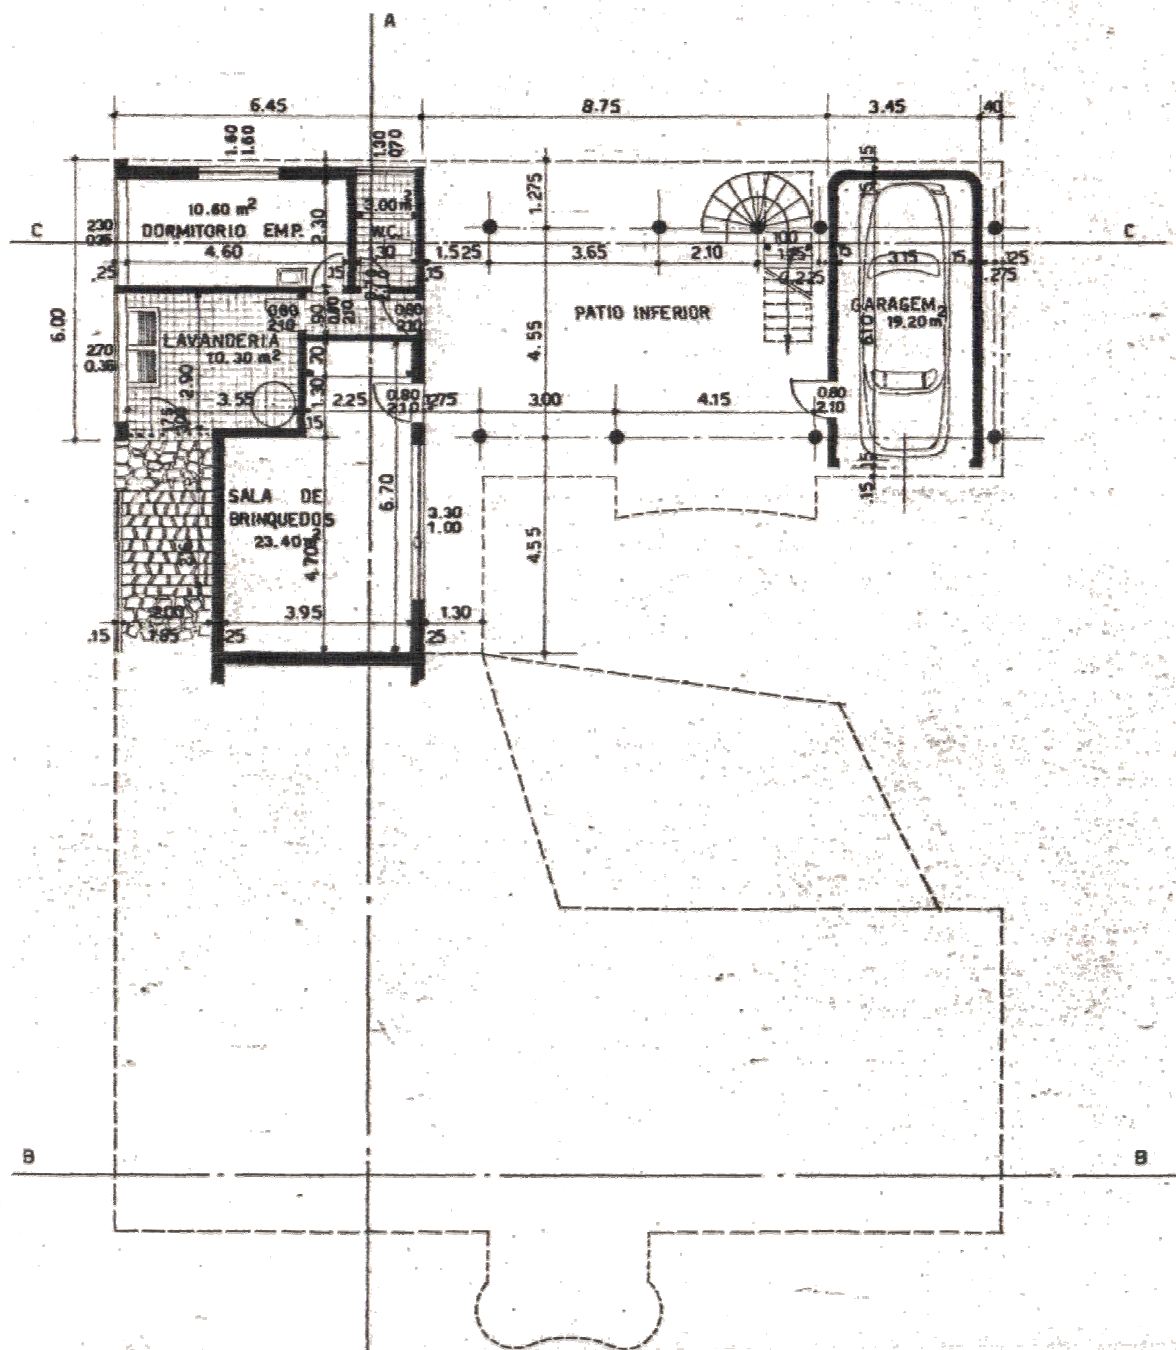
PLANTA PAVIMENTO INFERIOR
